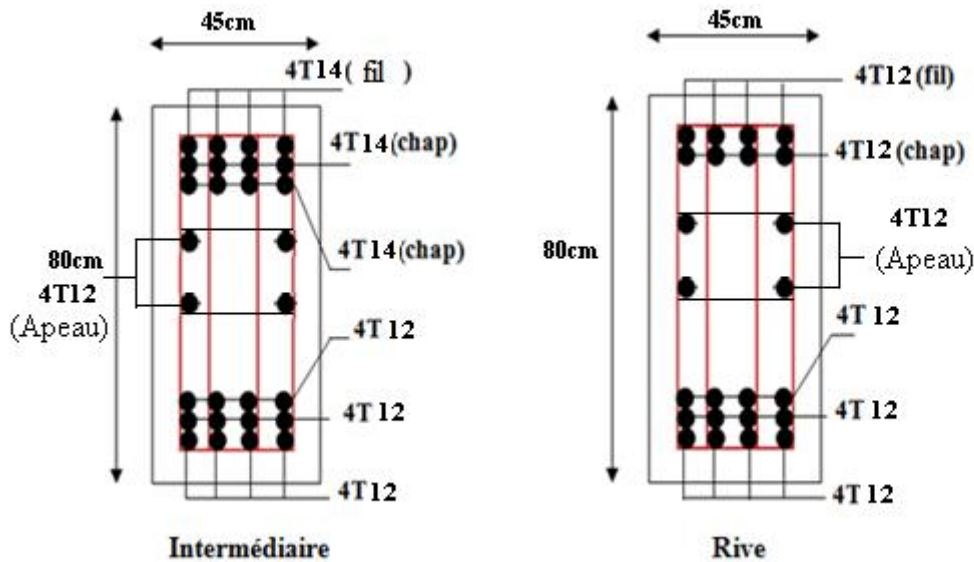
Ferrailage de la poutre de libage suivant le sens transversal.
